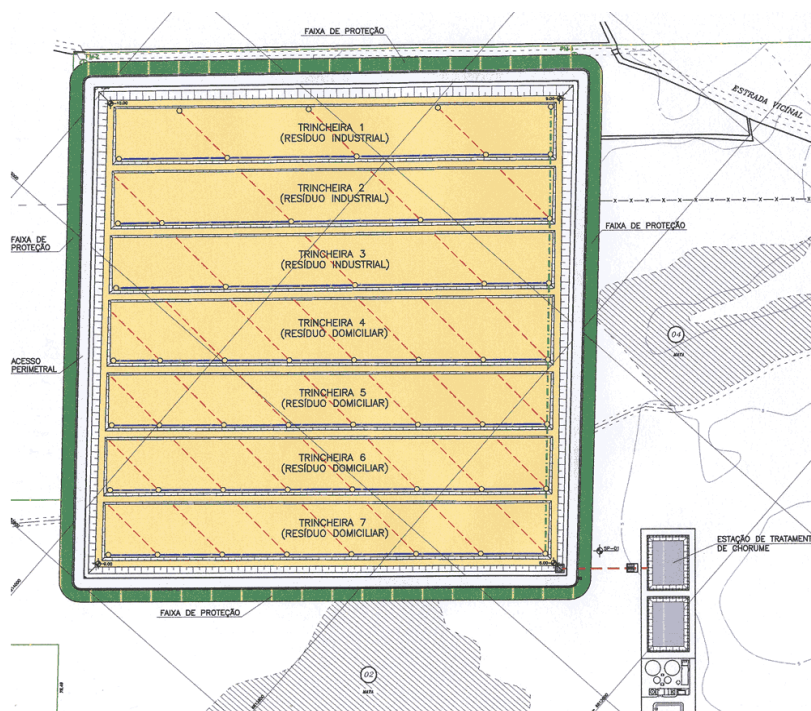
Planta baixa da área do aterro mostrando as células de disposição (Fonte: SANTEC, 2006).
